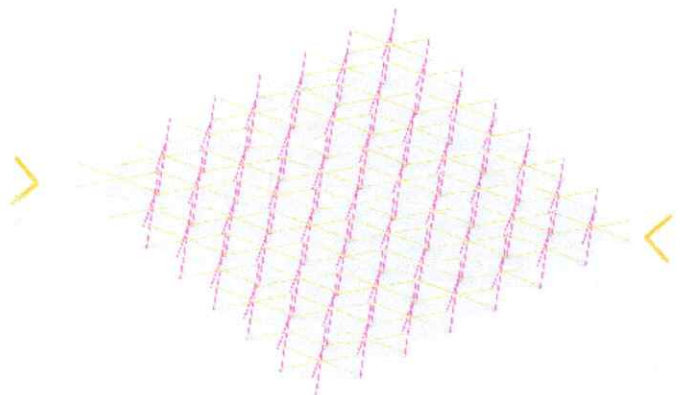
Barras articuladas según dirección de plegado. Fuente: Elaborado por el autor.
